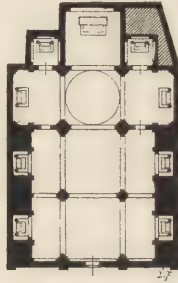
S. Bartolomeo zu Modena. Grundriss.
